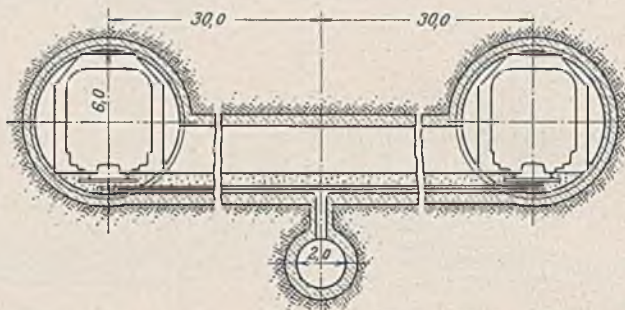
Doppelte Tunnelröhre im Meeresgrunde.
